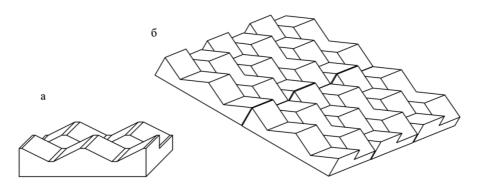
Блочные конструкции берегозащитных сооружений: а — гидротехнический блок для крепления берега б — фрагмент крепления берега
